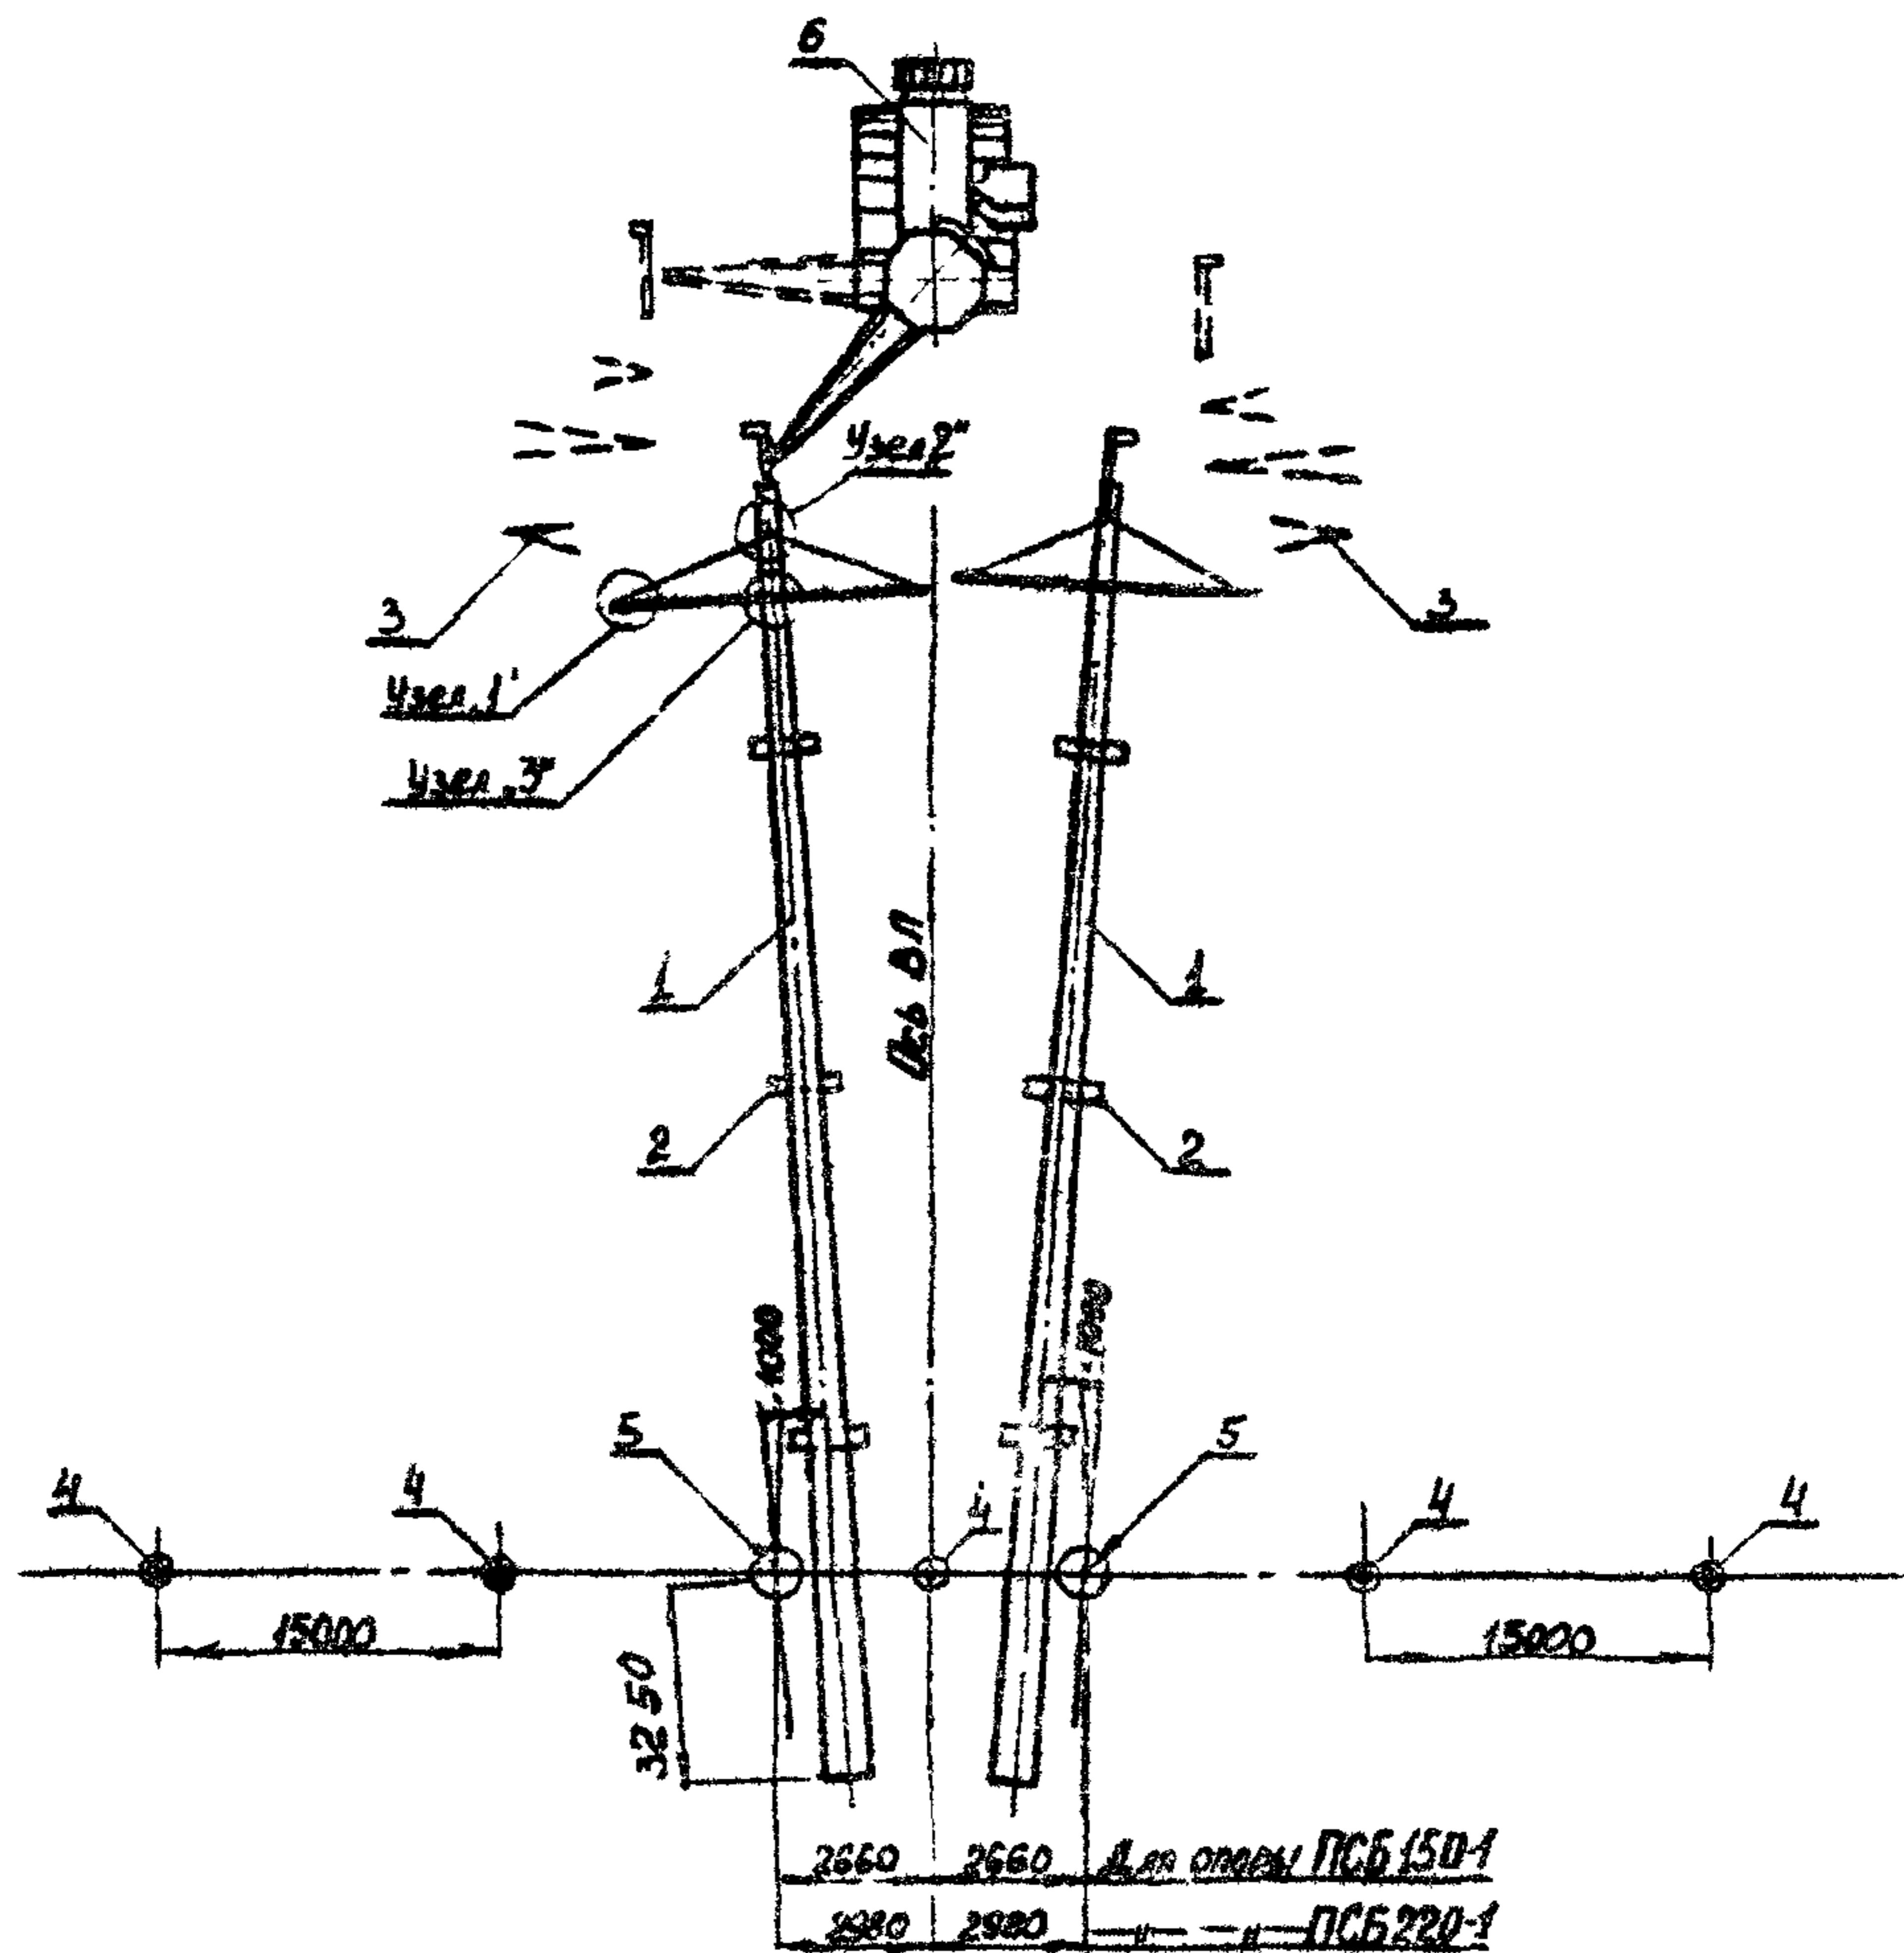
Схема выкладки стоек опоры и оснащение их металлическими деталями для подъема краном К-162 в стр. = 14 м
